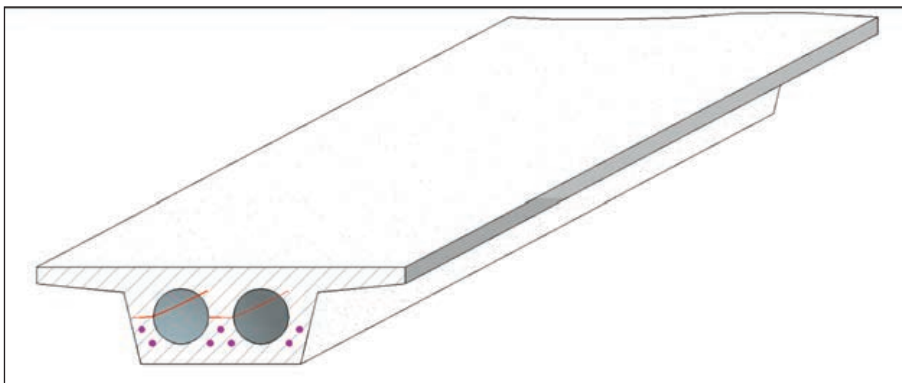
FISURAS EN EL ESPESOR MÍNIMO DEL ALMA DEBIDO A VALORES EXCESIVOS DE LA FUERZA DE PRETENSADO.
